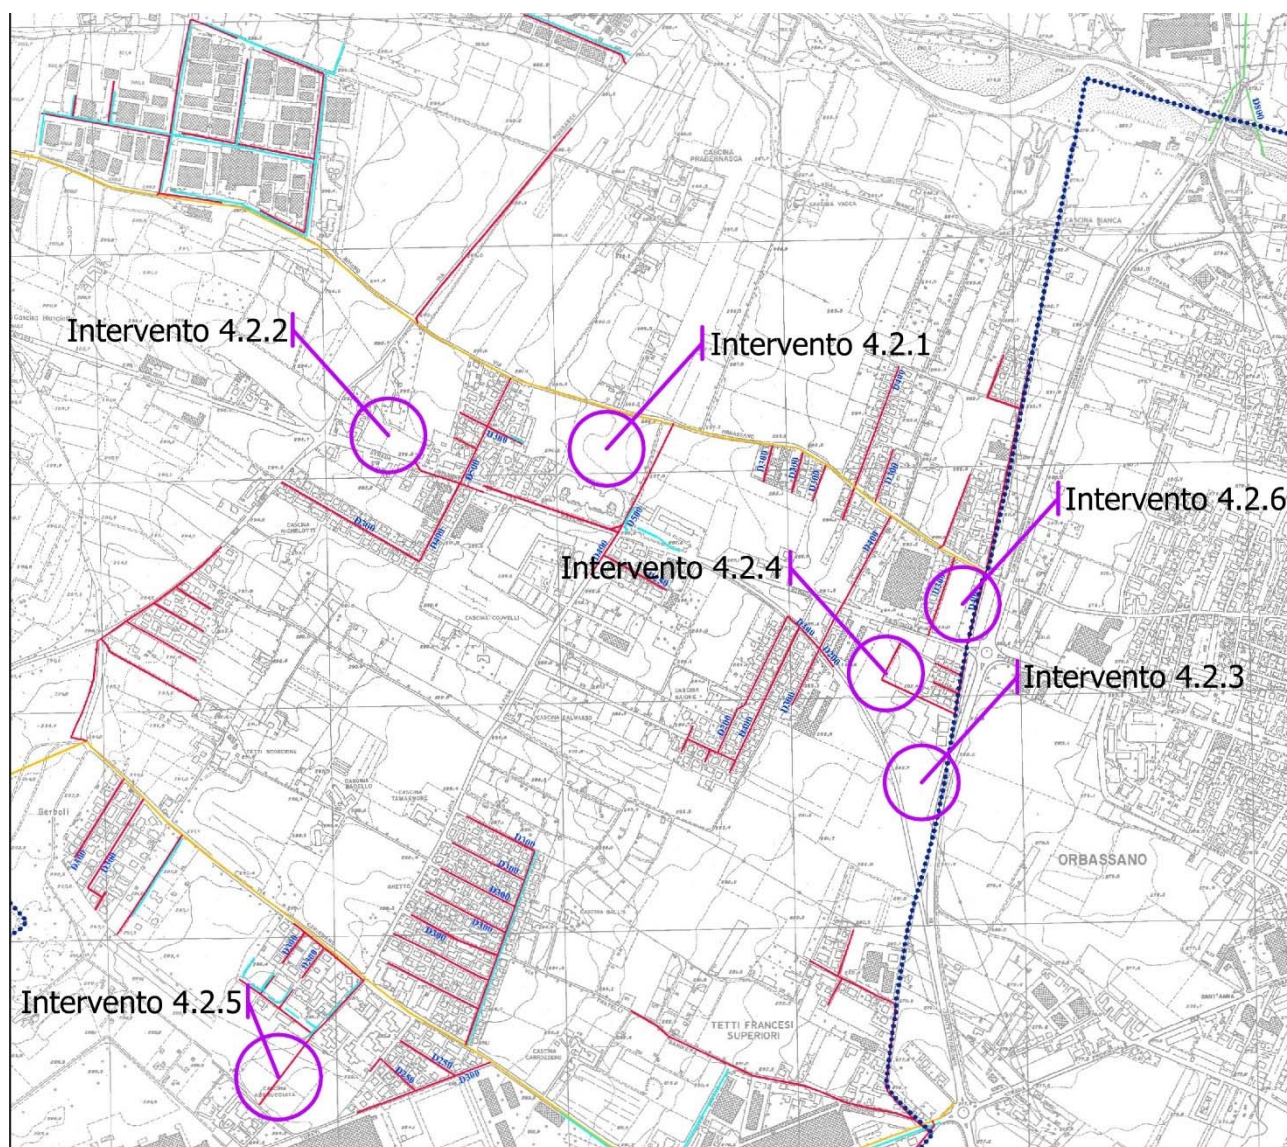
Estratto Allegato E della Relazione Illustrativa. Rete fognaria – Sud Sangone
